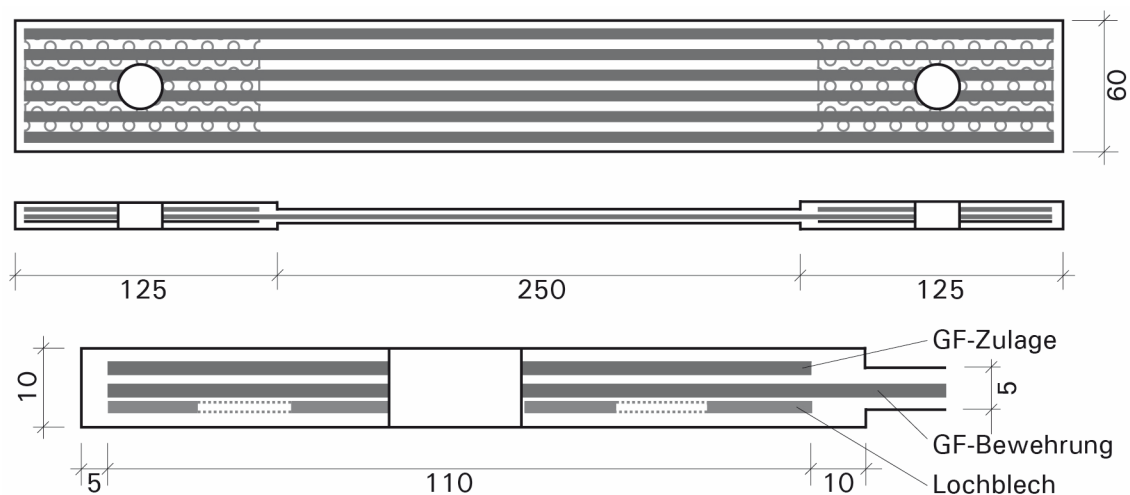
Prüfkörper mit Glasfaserbewehrung
